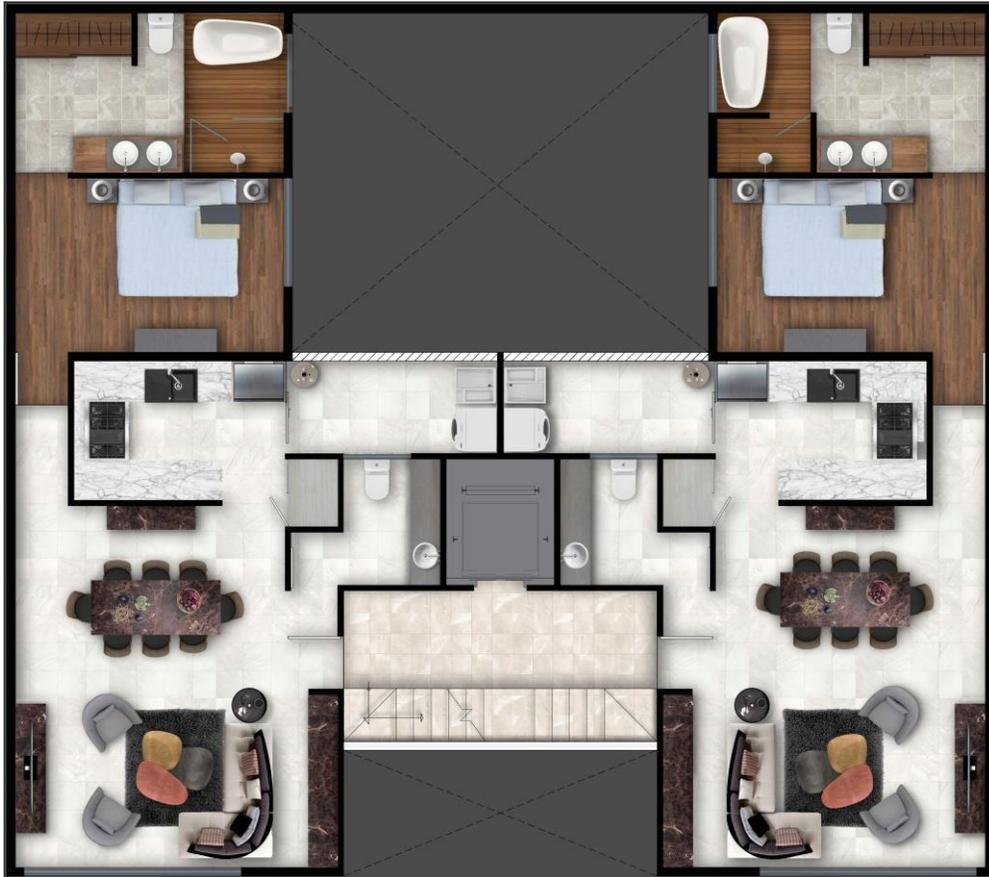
Planta tipo B, desarrollo de anteproyecto
